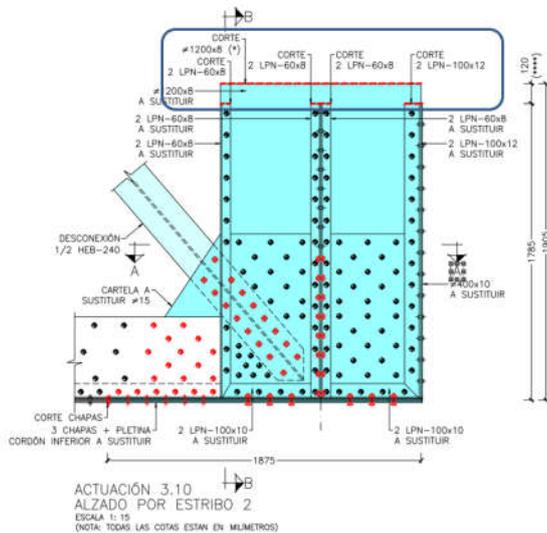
Nudo inferior mamparo de pila. Corte de angulares
